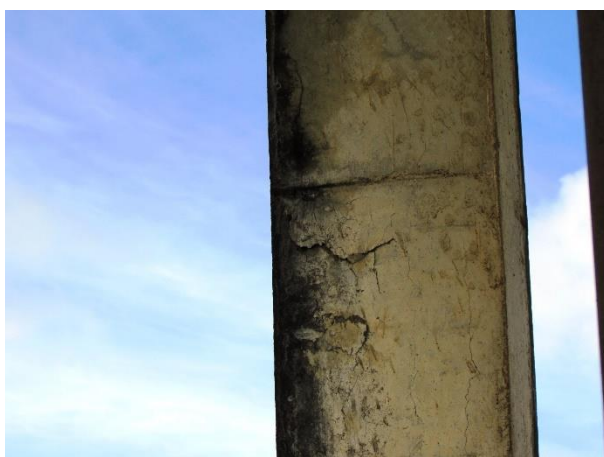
Vista anterior aproximada do pilar no 3º lance com trincas generalizadas
